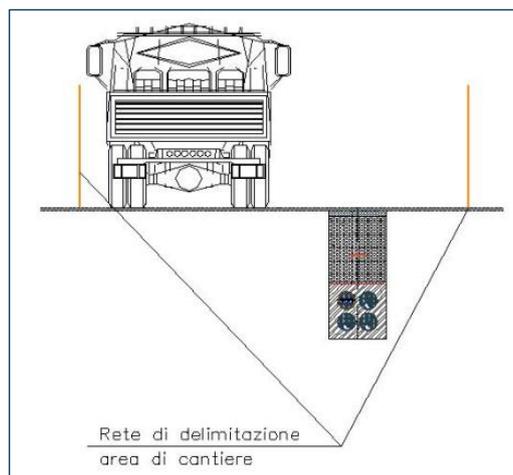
Sezione tipo area di cantiere per posa cavidotto mediante trincea.
